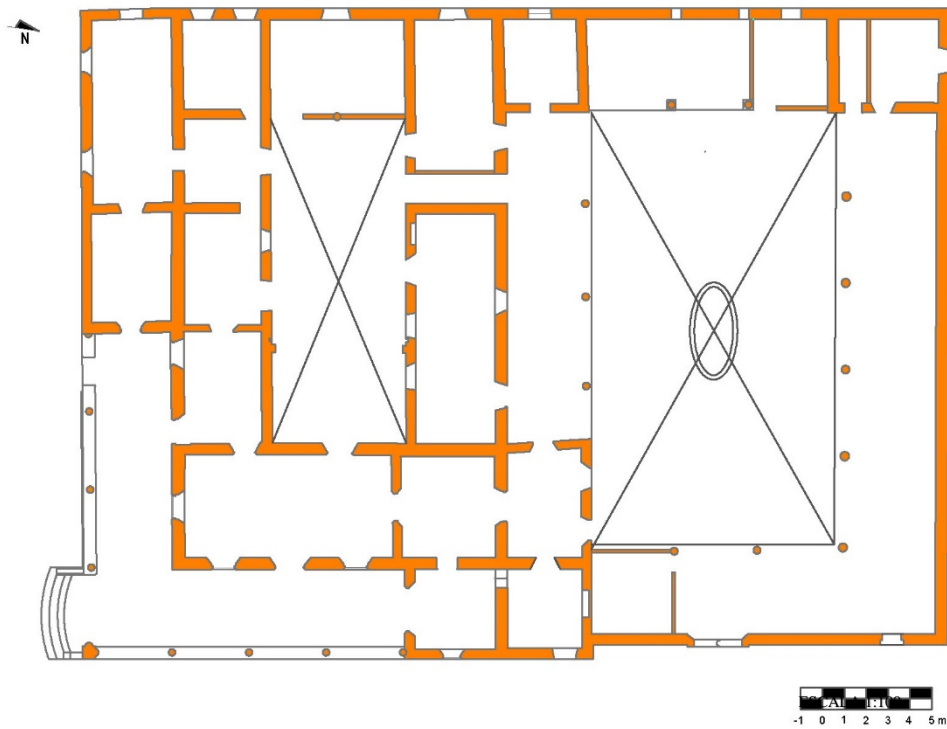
Plano de la Casona entre 1930 y 1943 (Modificado de Del Castillo, 2008).
